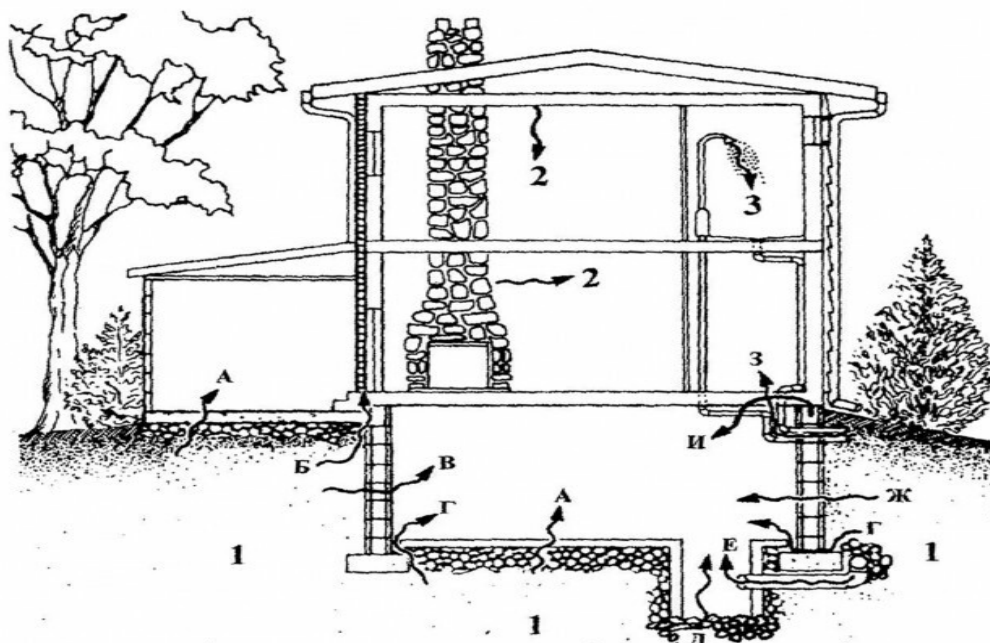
Основные источники (1 - 3) и пути проникновения (А - З) радона в здания. 1 - почва под зданием, 2 - строительные материалы, 3 - вода из подземных источников; А - трещины в бетонных перекрытиях, Б - пространство за облицовочной стеной, установленной на перекрытом фундаменте из полых блоков, В - поры и трещины в бетонных блоках фундамента, Г - соединения между полом и стенами, Д - открытая почва (например, в дренажном колодце), Е - швы между блоками фундамента, заполненные раствором, Ж - плохо изолированные вводы труб и коммуникаций, З - открытые торцы пустотелых блочных стен
